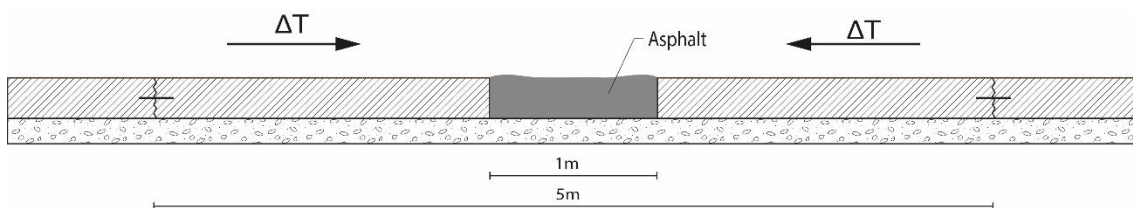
Fall 1 A - Betondecke ohne Verbund zur HGT erwärmt sich, Asphalt wird an den Rändern verformt
